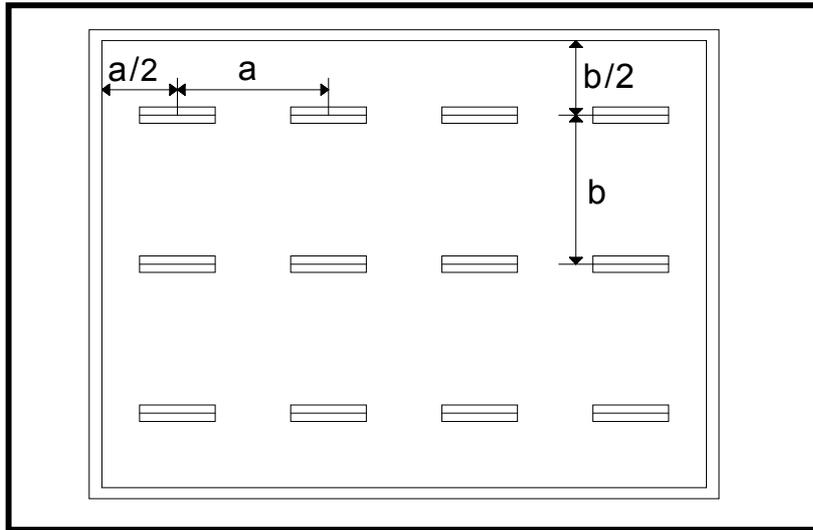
Distribución típica de luminarias en planta uniforme: la distancia desde las paredes a los artefactos es igual a la mitad de la separación entre ellos.
